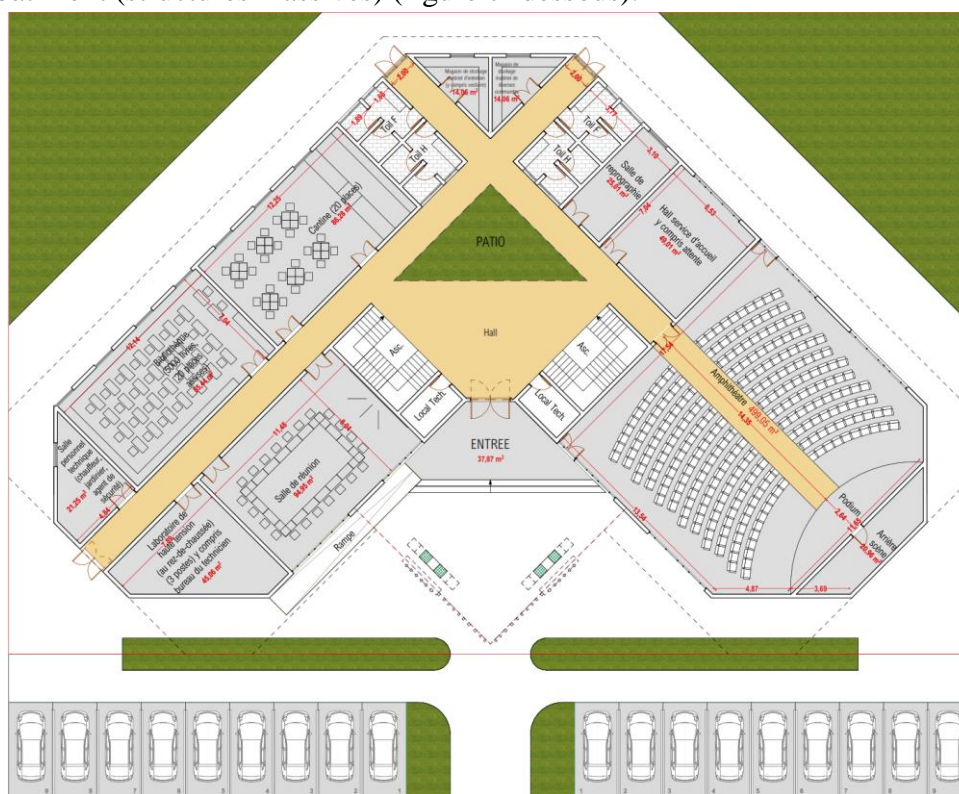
Aménagement du rez de chaussée et de l'extérieur
